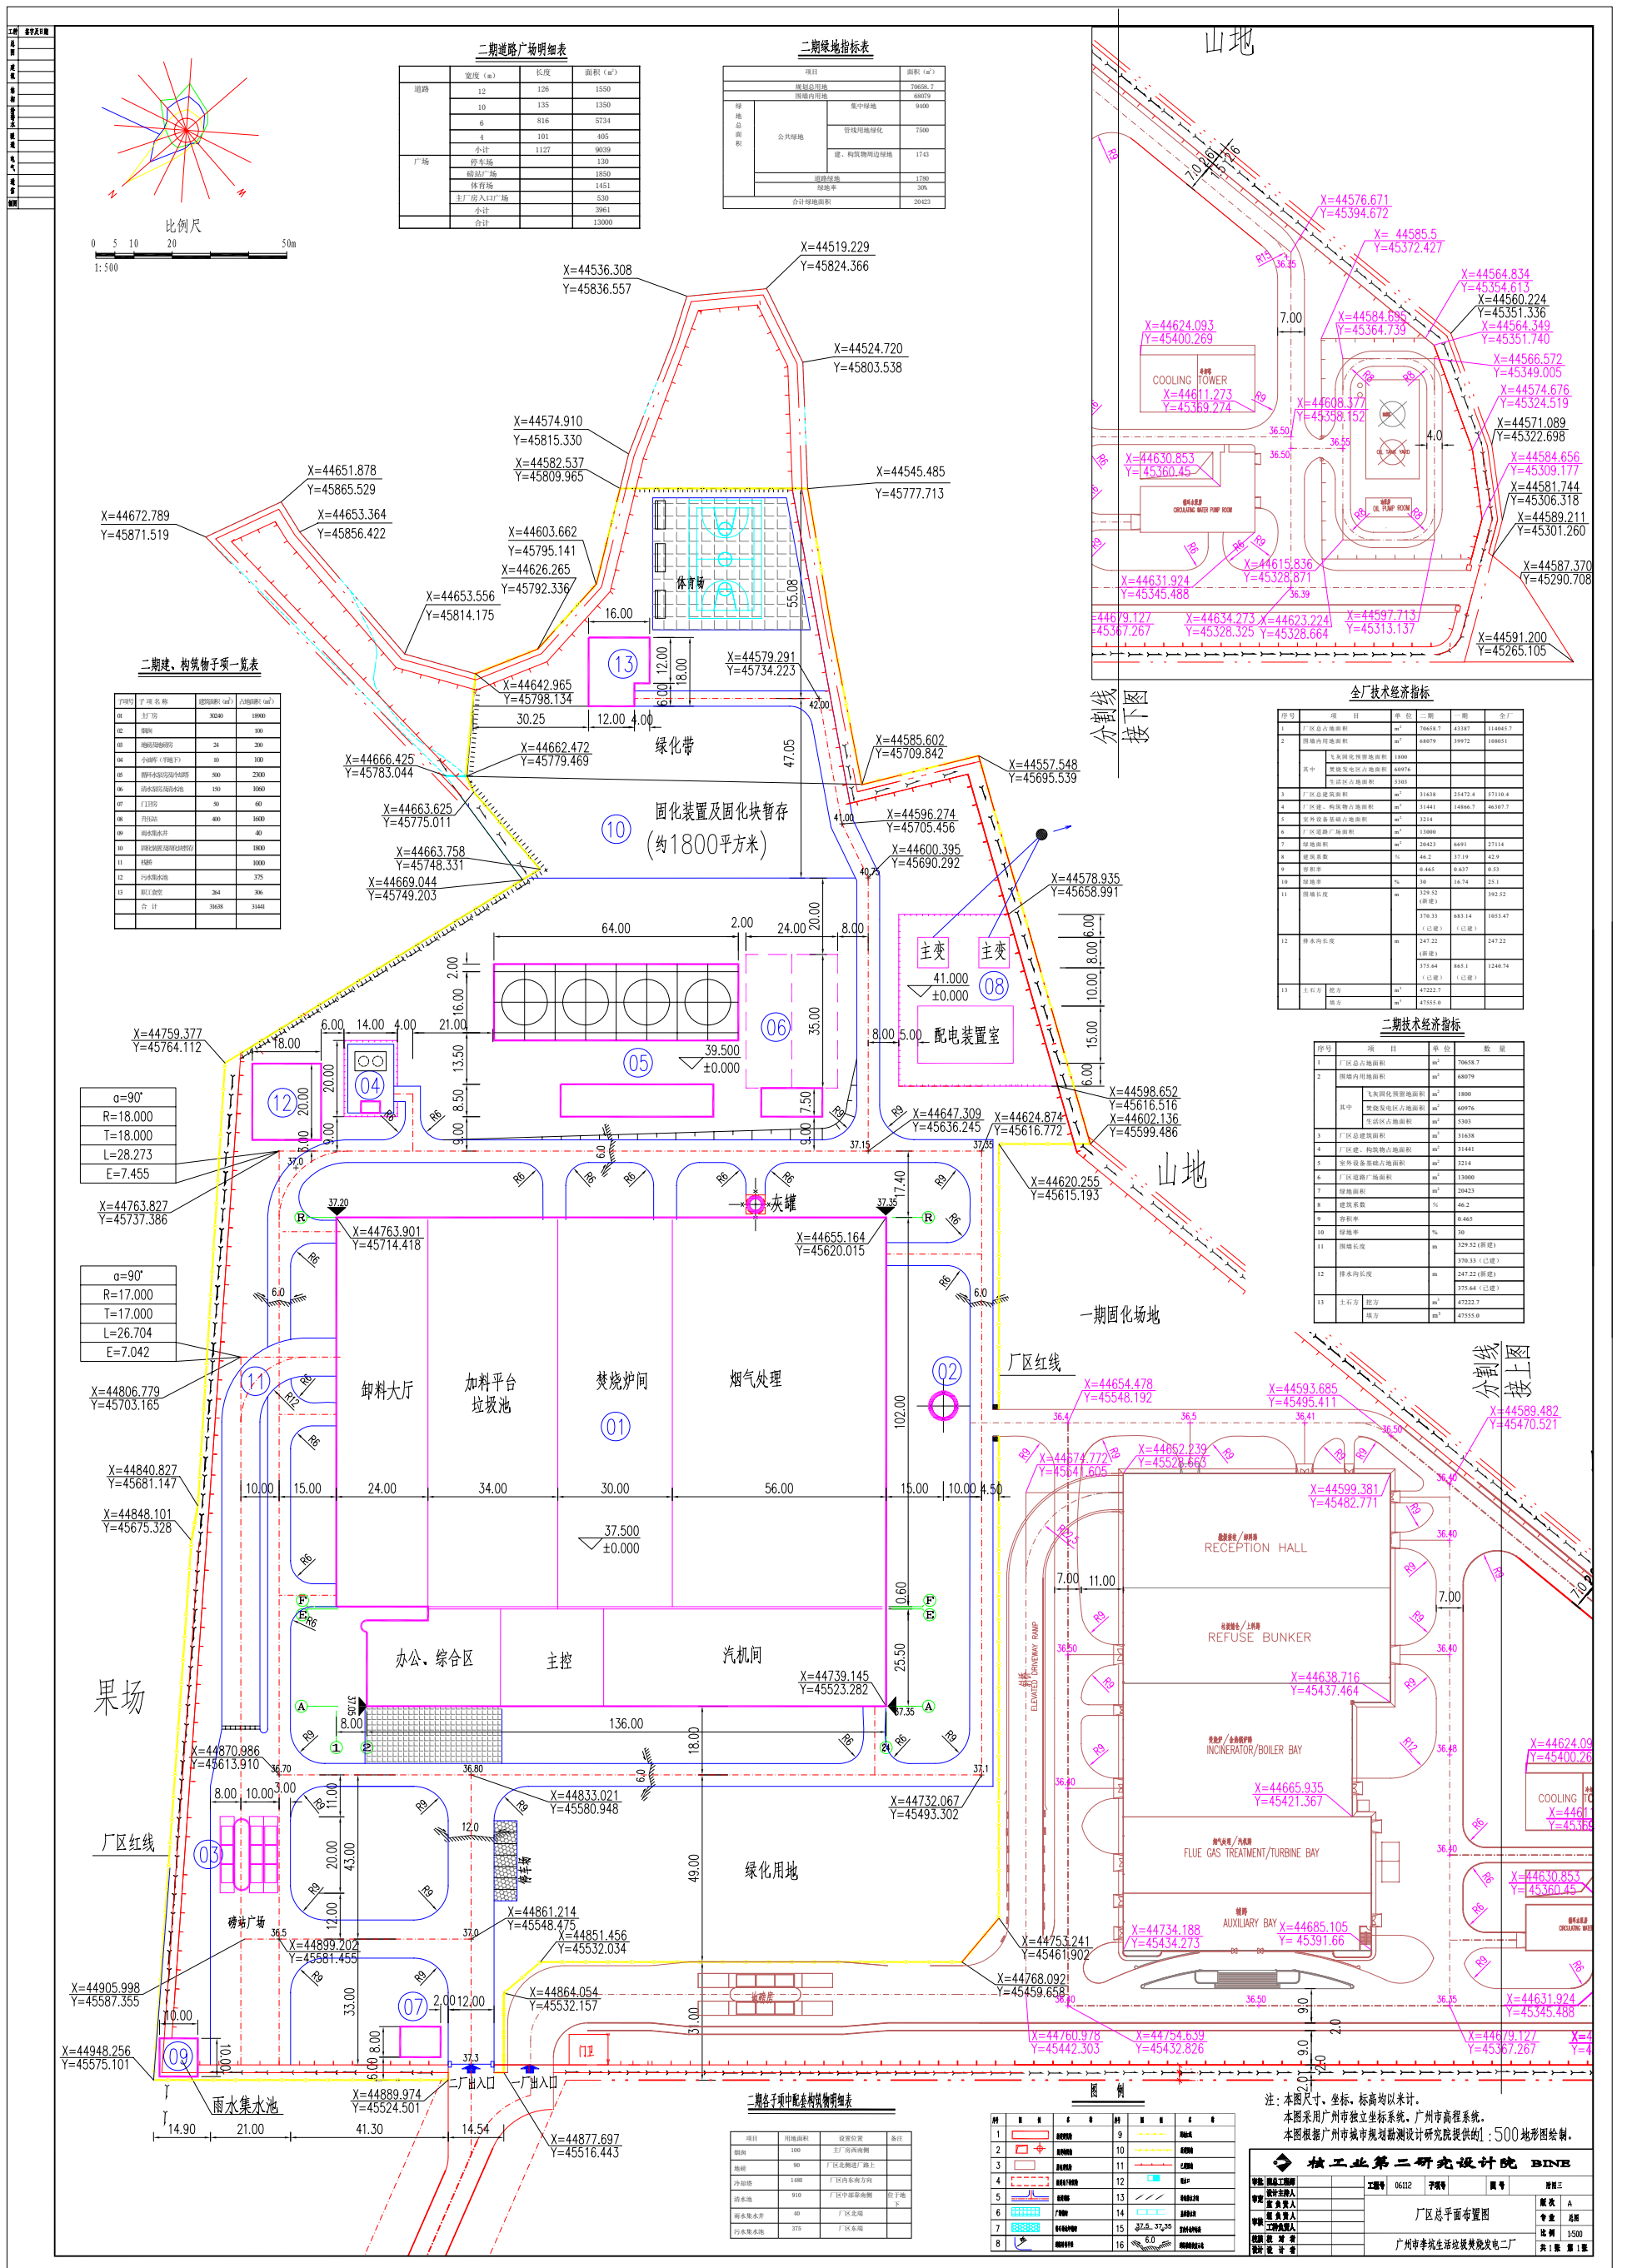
李坑垃圾焚烧二厂项目平面布置图
